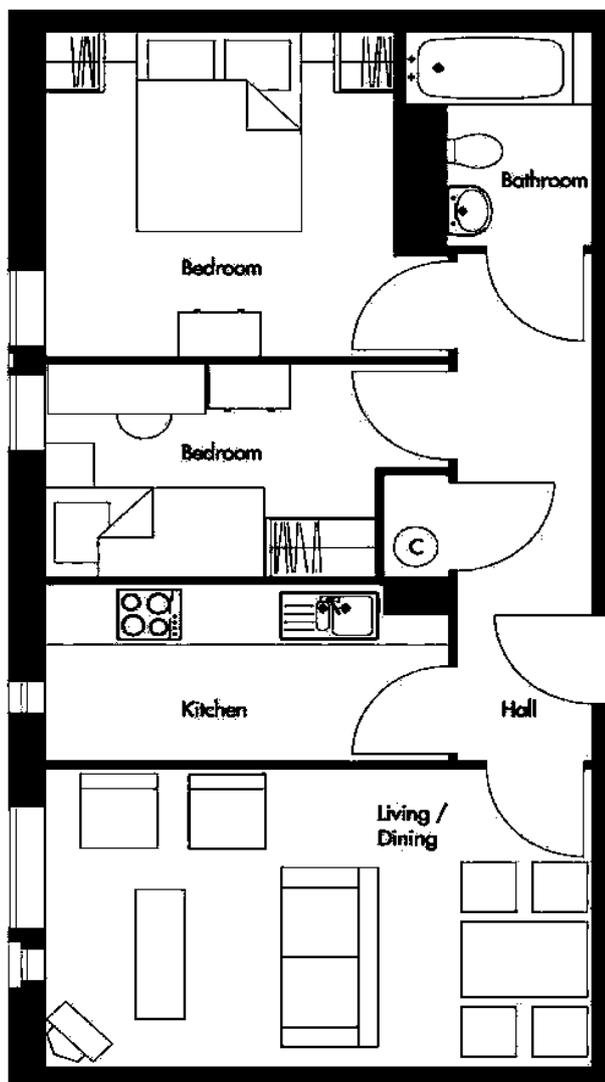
West Cambridge Site. Planta de departamento de dos habitaciones
